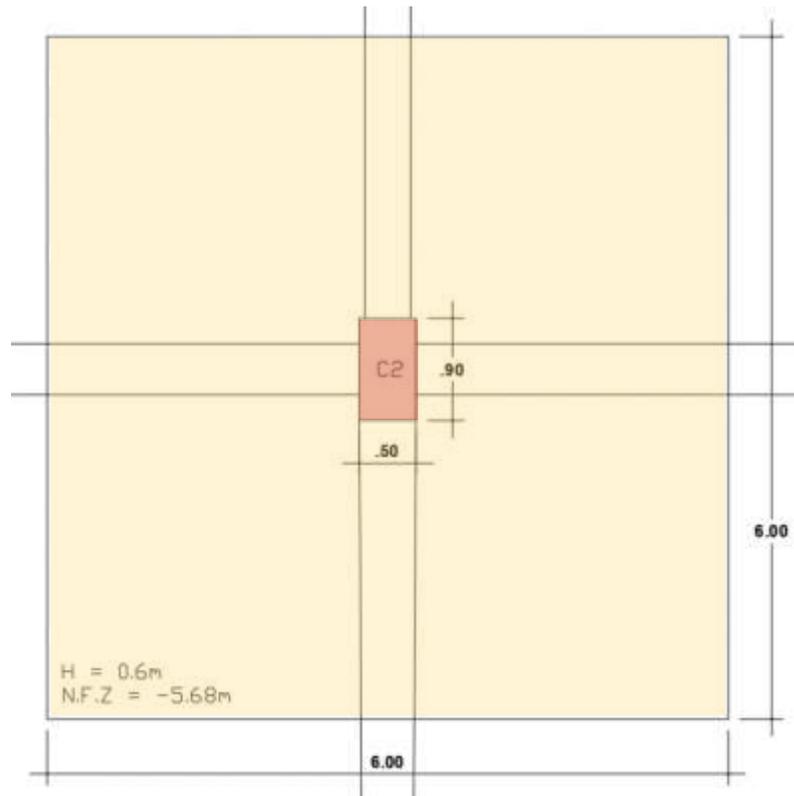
Zapata. Ver plano 61_E02_Plano de cimentación eje B. Elaboración propia.
